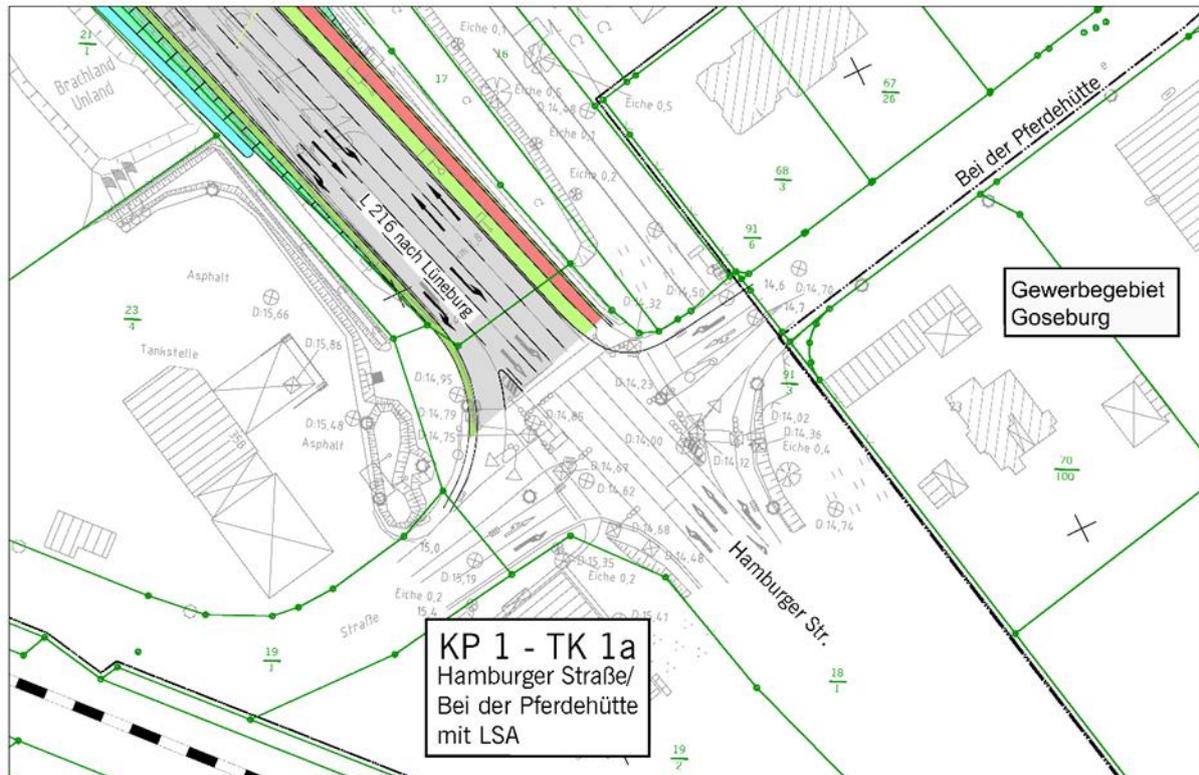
Auszug aus dem Lageplan (Unterlage 5 Blatt 1)
